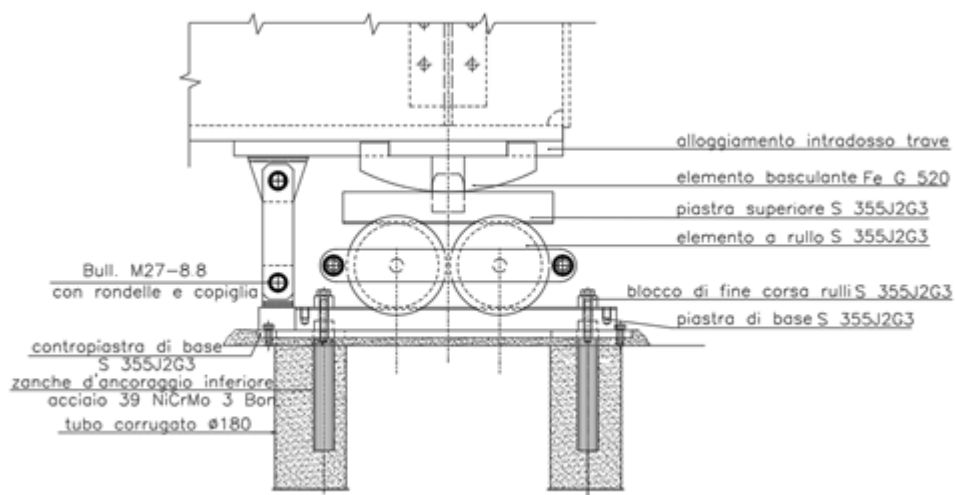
Sezione longitudinale dispositivi di appoggio unidirezionale
